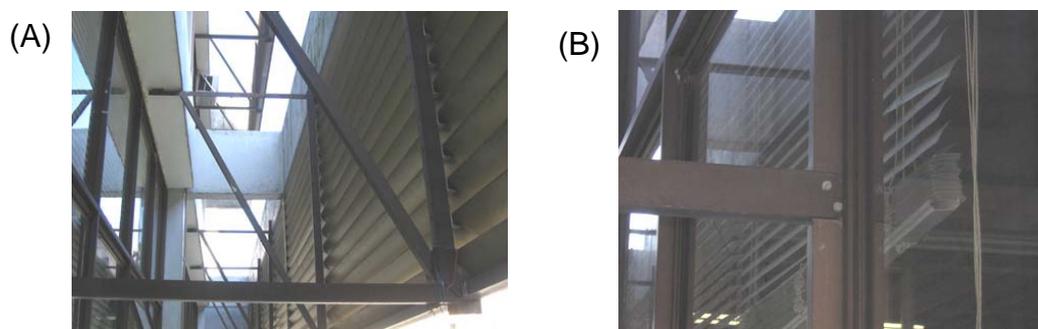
(A) fixação dos painéis na estrutura (B) fixação da estrutura nos montantes das janelas
